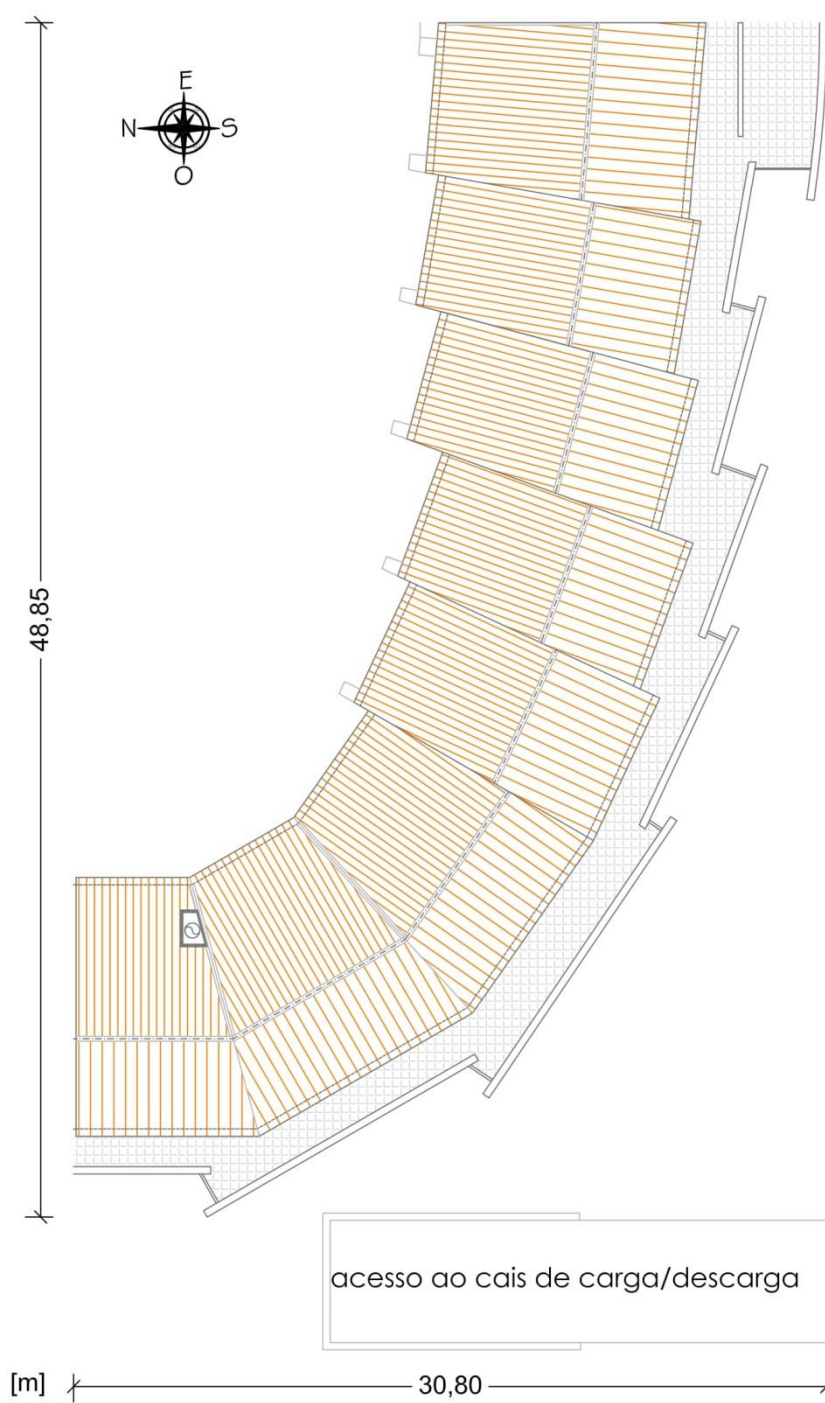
Planta Arquitetónica do Piso 2 (terraço) e da Cobertura inclinada: corpo F (s/escala).
